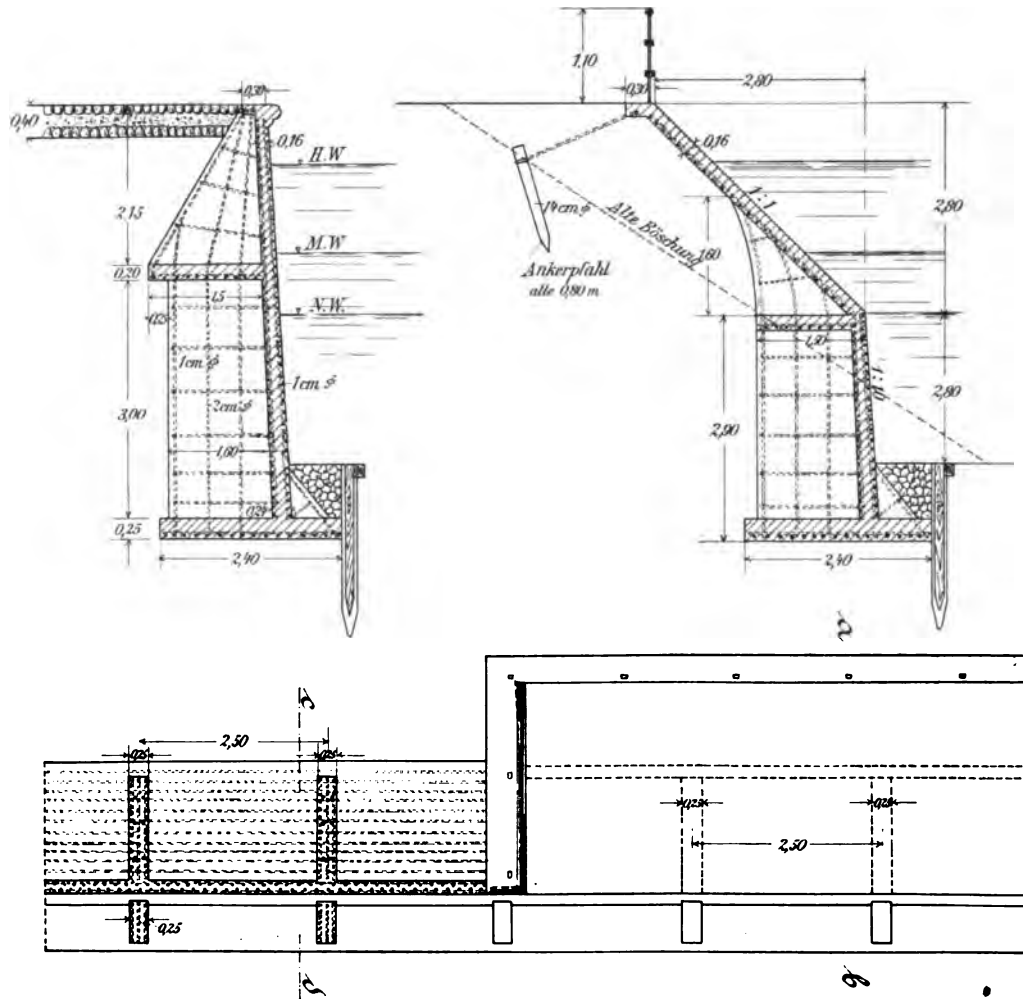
132. Stützmauer und Uferdeckung in Eisenbeton.
